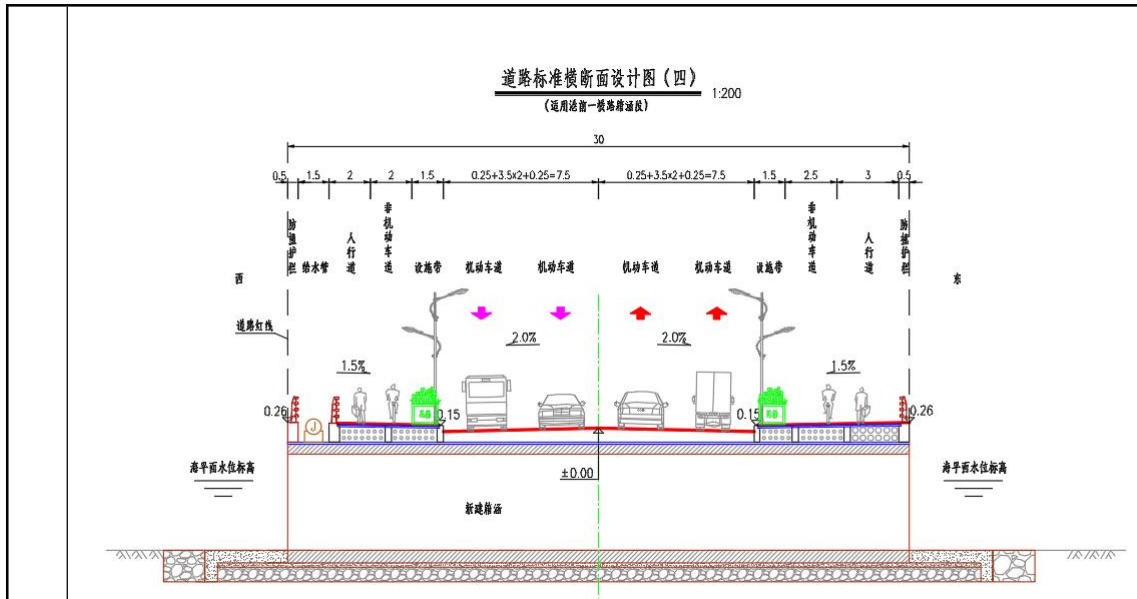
港前一横路箱涵段横断面图 (单位: m)
